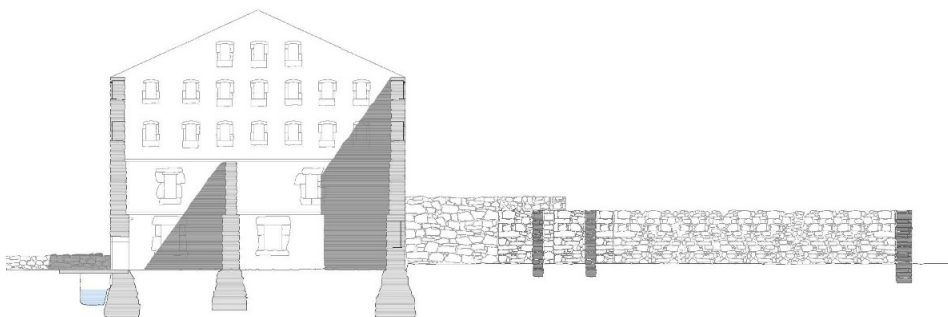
Levantamiento. Estado actual. Sección transversal fábrica
